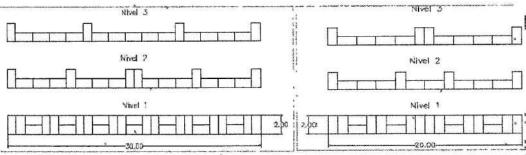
Detalle en planta de gaviones en márgenes del cauce en cruce de tubería de sistema GALÁN – AYACUCHO 8" en PK 99+130 a PK 99+370. Fuente: CENIT, 2024.
